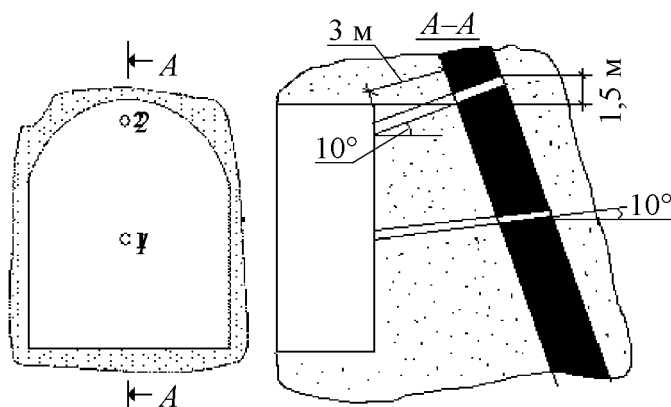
Схема расположения скважин в забое подготовительной выработки при вскрытии крутопадающих угольных пластов
